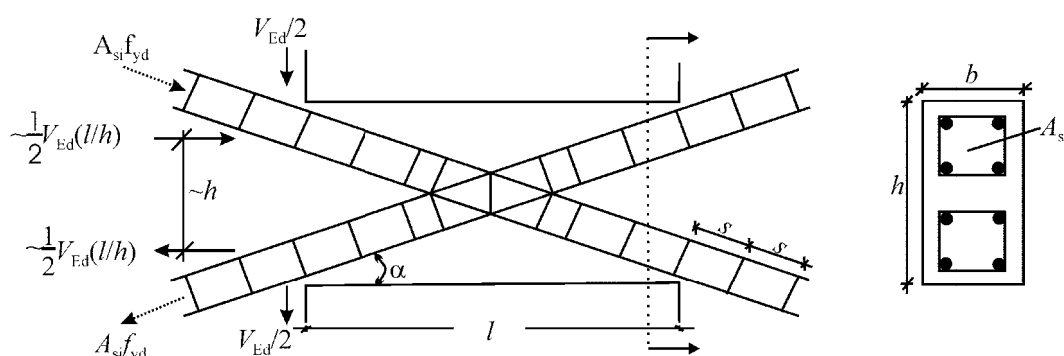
Vigas de acoplamiento con armadura diagonal
